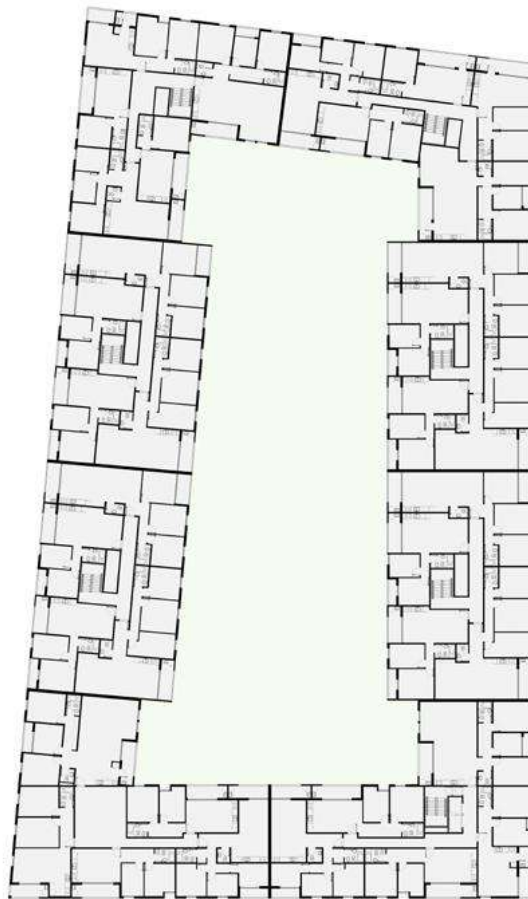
Planta de una de las manzanas en donde se puede observar la resolución de las viviendas que no responden a una tipología sino que se presentaban múltiples soluciones de planta. Las viviendas de las tiras centrales, las únicas que se repetían, tenían ventilación e iluminación hacia ambos lados (Extraída de Power Point presentado por el IVC en Asamblea del 28 de julio de 2017).
